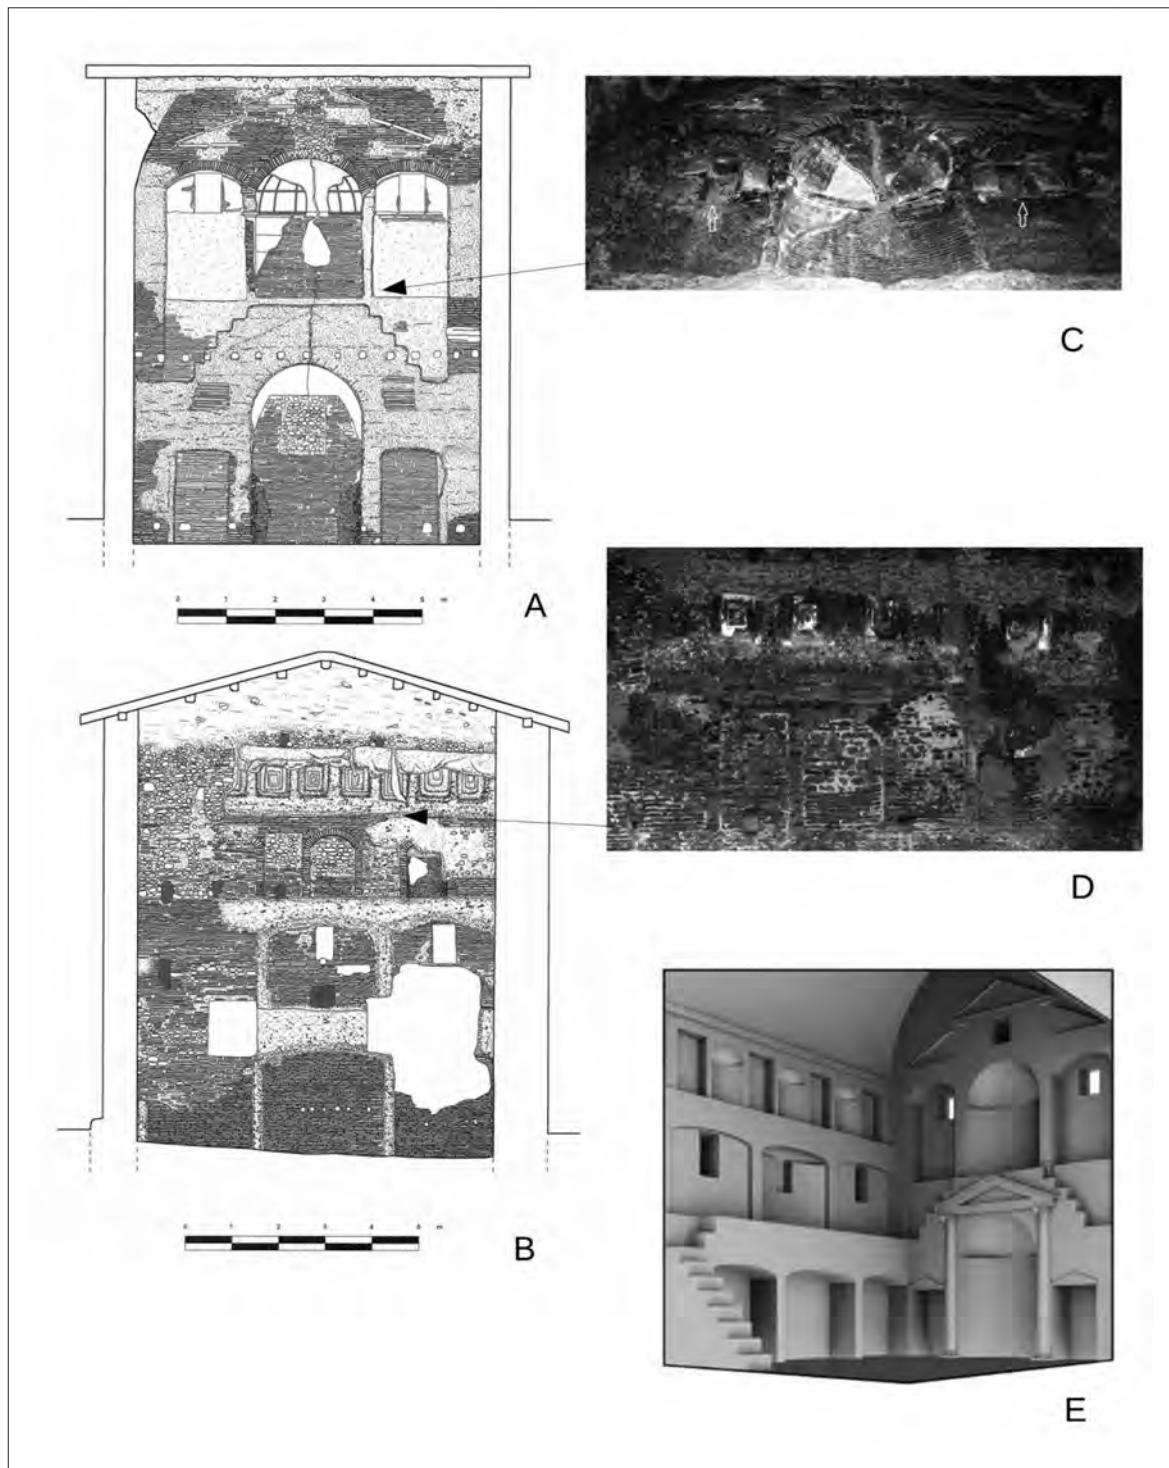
Prospetti interni della parete di fondo (A) e della parete laterale sinistra (B). Particolare del secondo ordine di nicchie della parete di fondo (C) e della volta cassettonata sulla parete laterale (D). Ricostruzione 3D dell'interno (E) (dis. e foto C. Fasciani, F. Salamone).
